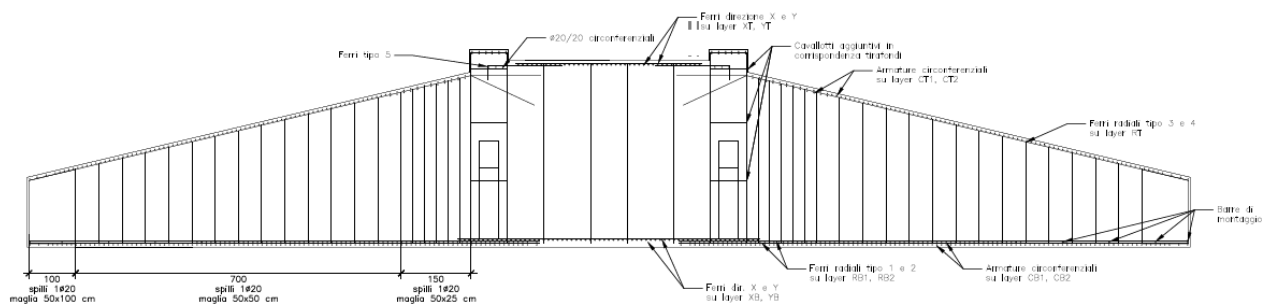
Sezione plinto di fondazione - identificazione armatura
